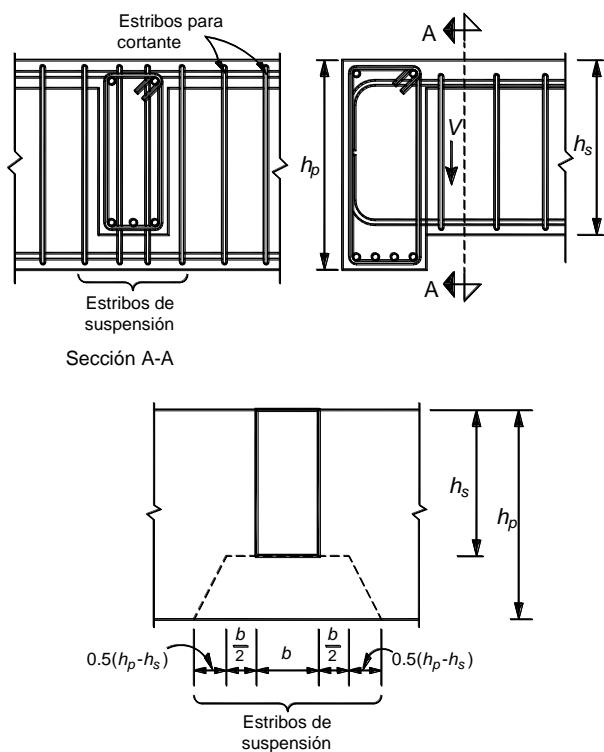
Transmisión de fuerzas y conexión entre vigas secundarias y principales
